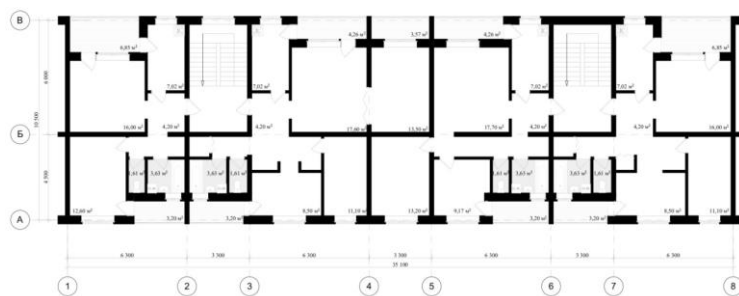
План пятиэтажной блок-секции жилого дома (секция 2-4-3-3) серии 135
